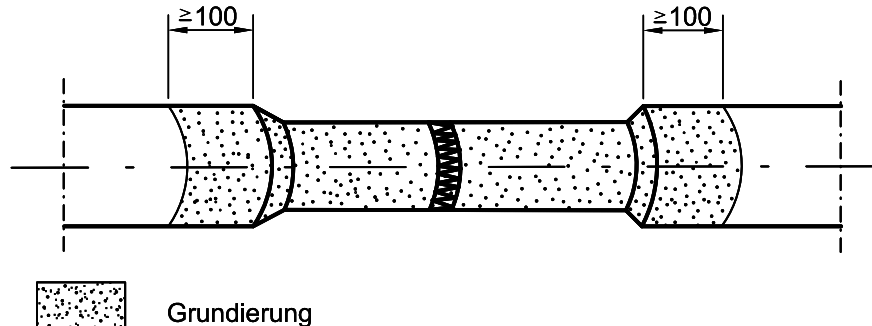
Grundierung auf dem Nachumhüllungsbereich
